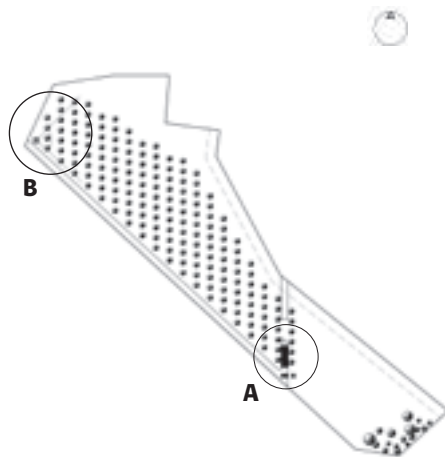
Planta de emplazamiento. A. Casa original. B. Casa del vigia.
